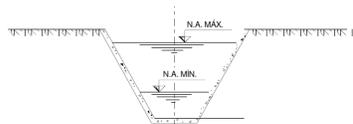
Canal em concreto – Seção trapezoidal com base reduzida.
